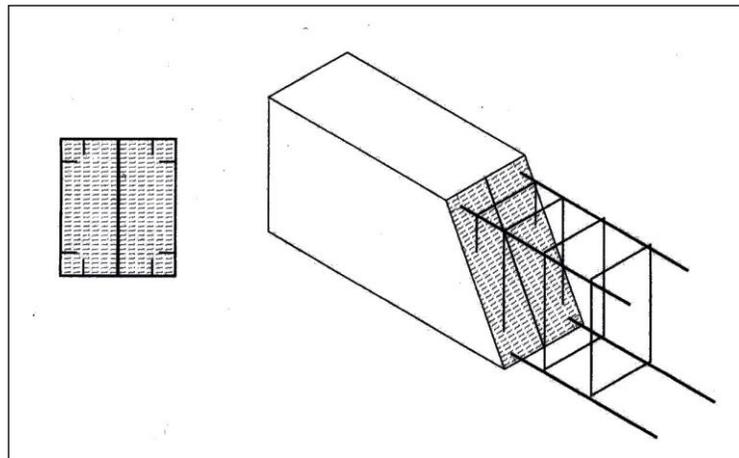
Esquema de la malla con vena y su colocación. (© Asocreto)
